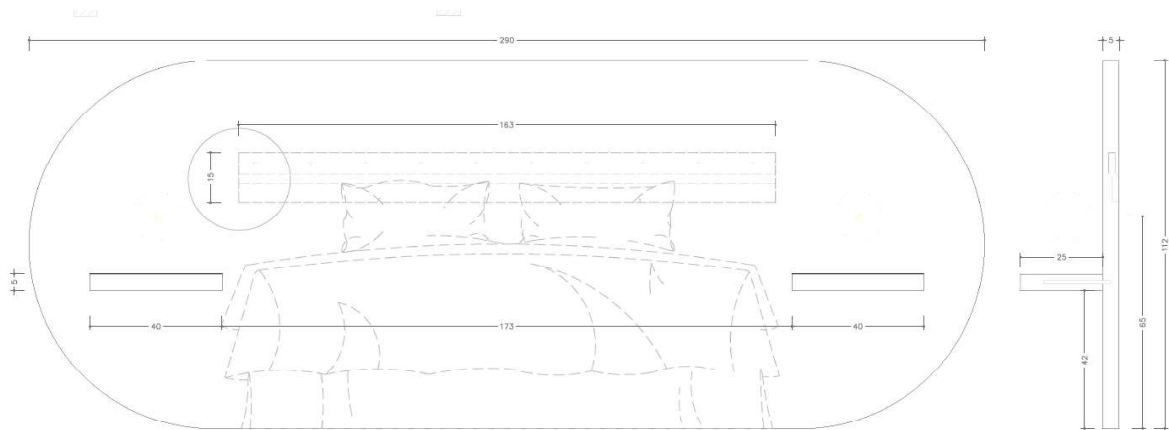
Planta e vista 3d quarto azul (Projeto VM). Fonte: Autora.
